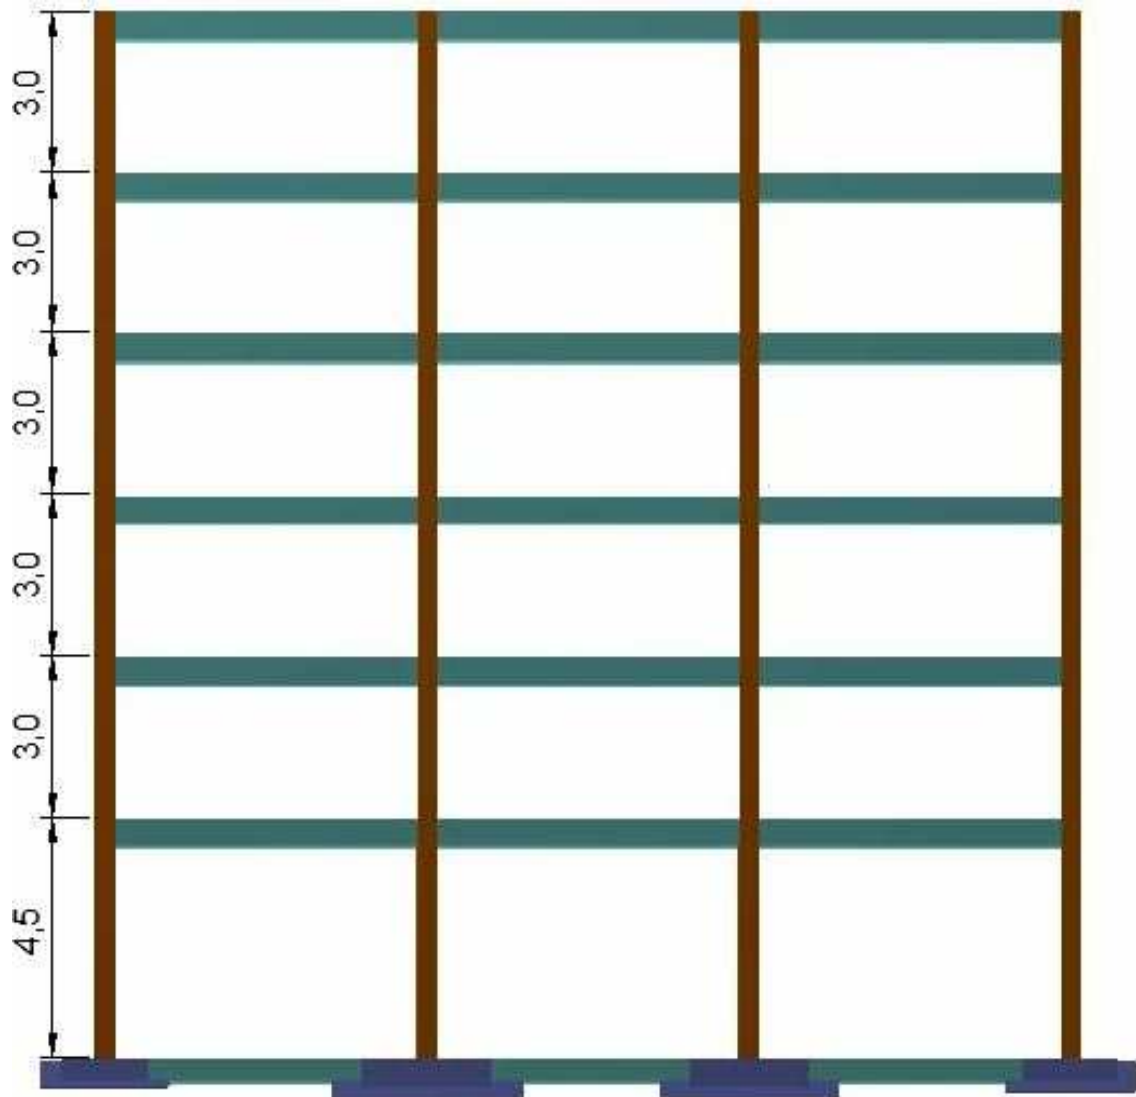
Vista en perfil. Edificio de 6 plantas.
